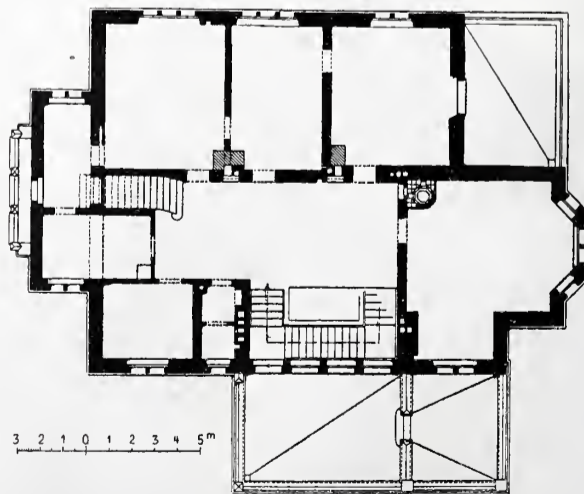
Grundriss vom ersten Obergeschoss.
